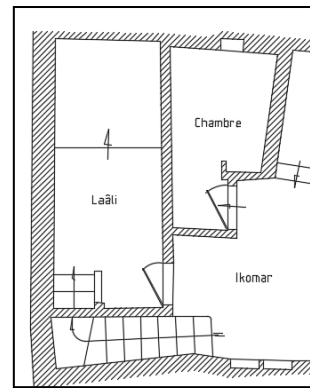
l'aali sur le plan. *Source : plan modifié par l'auteur.
